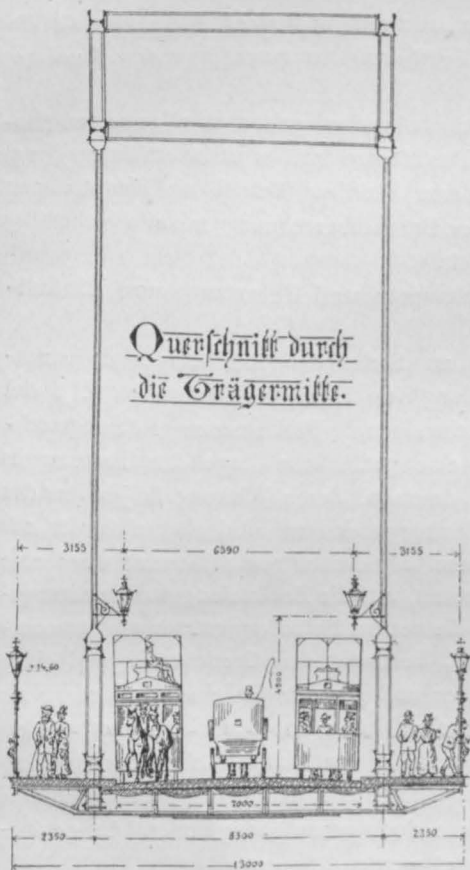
Belastung der Fahrbahn einer Straßenbrücke.
